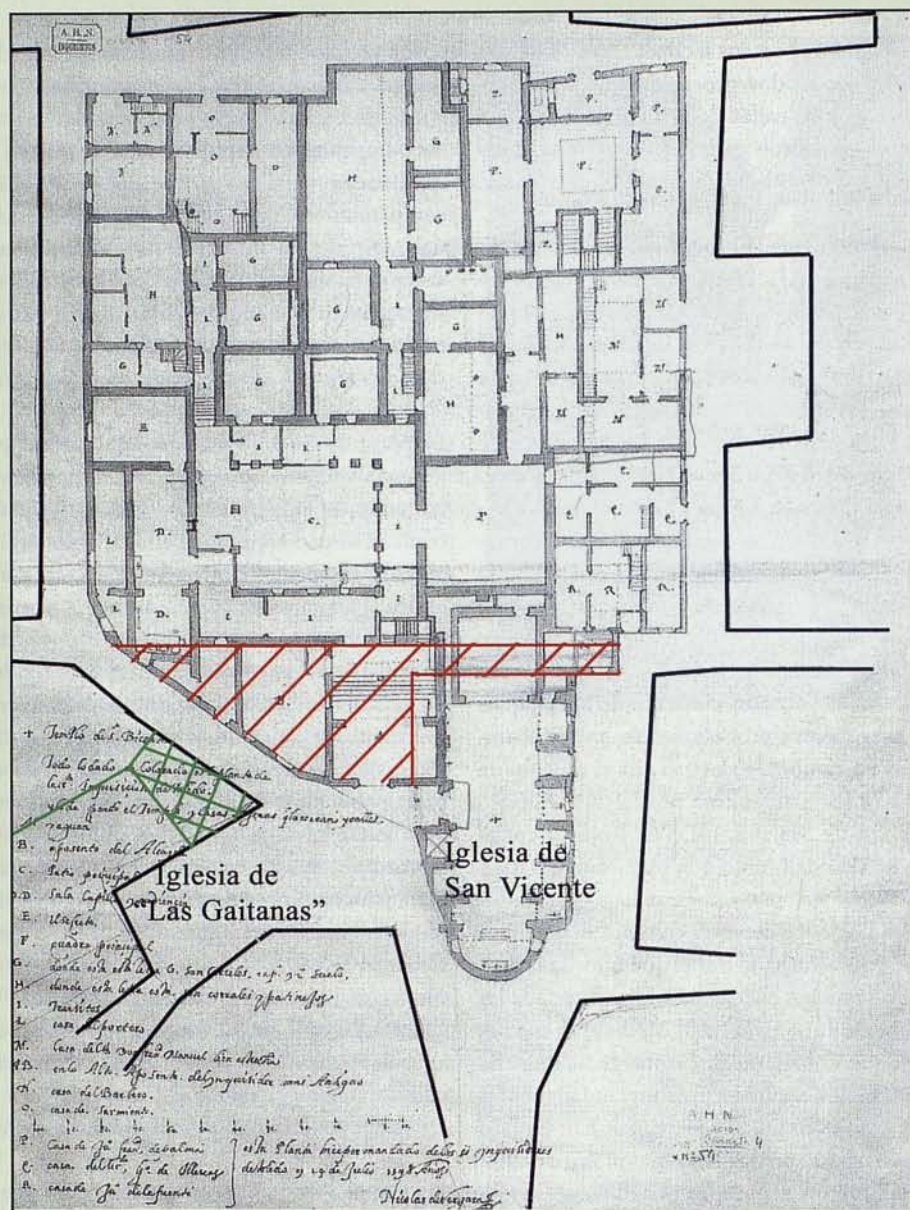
Plano de Nicolás Vergara el Mozo (1598) en el que aparece la planta de las casas inquisitoriales, demolidas por el Cardenal Lorenzana para construir la universidad.
